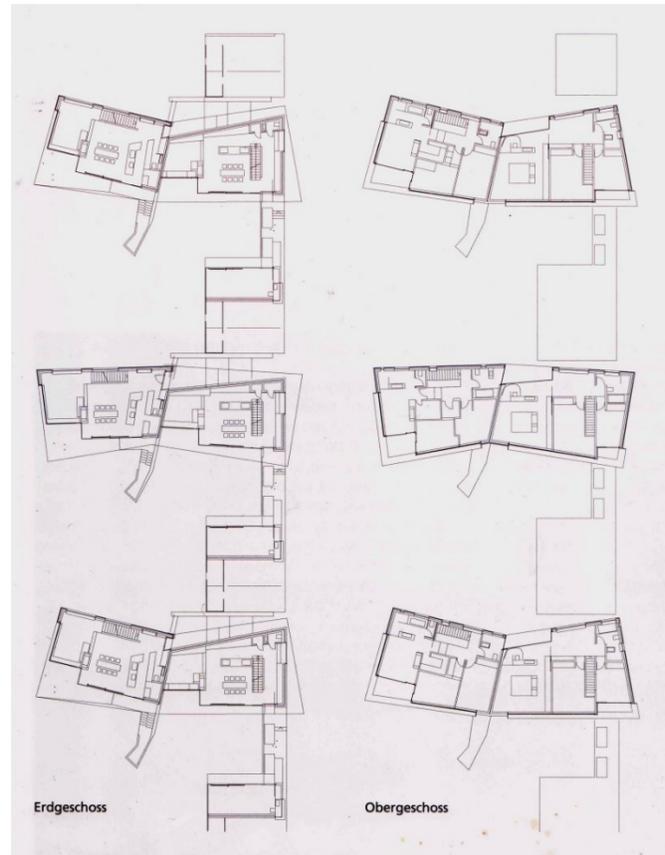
Grundriss Erdgeschoss und Obergeschoss
